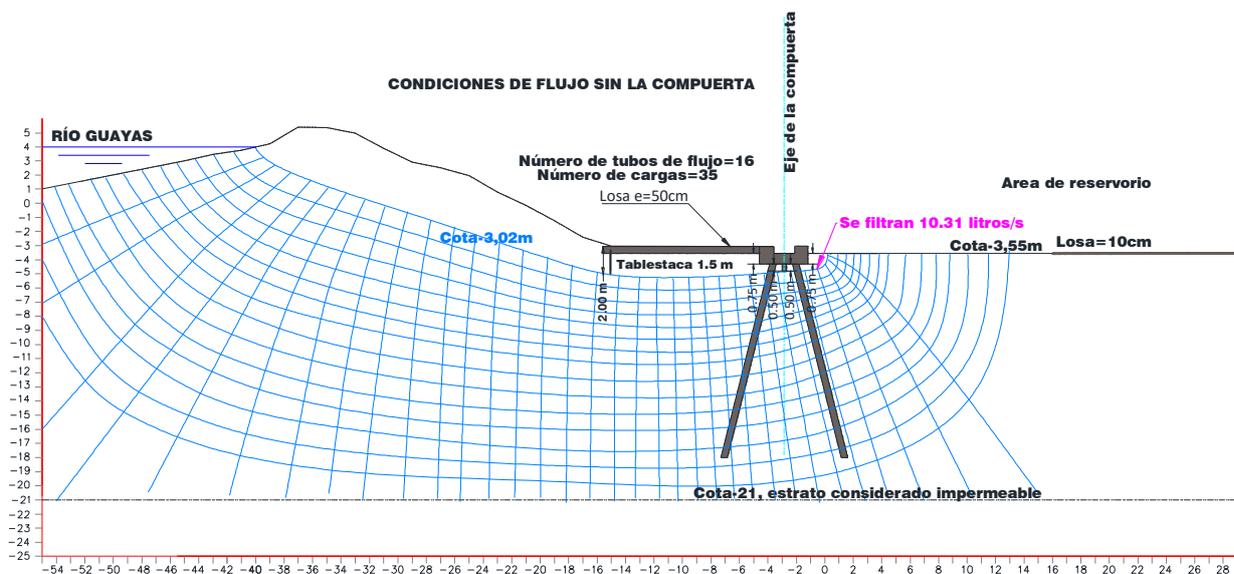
Perfil topográfico actual, la base y cimentación de la compuerta, la losa externa y las tablestacas menos profundas (1.5m), sin la compuerta.
